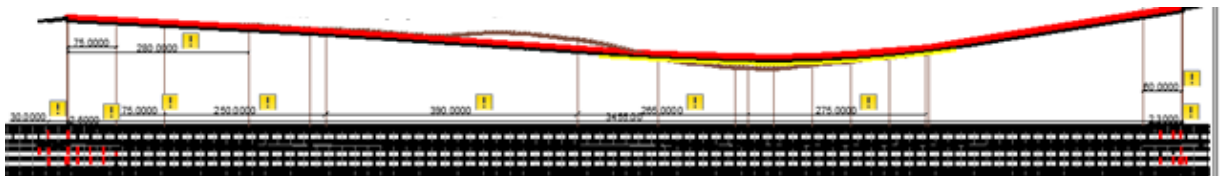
Фрагмент поздовжнього профілю аеродрому Житомир
